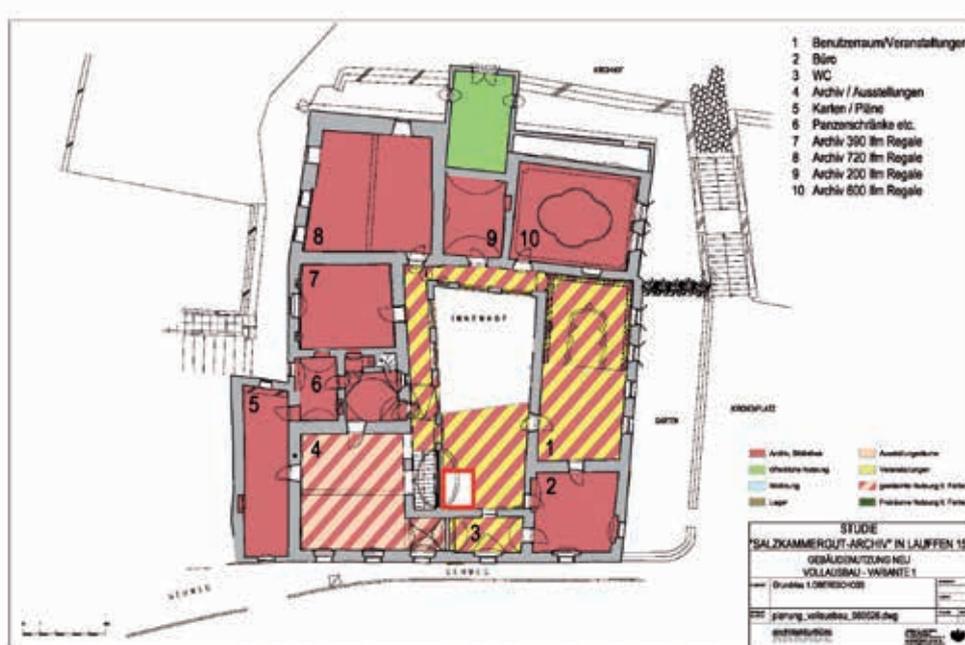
bis 16: Ausschnitte aus der Studie von 2008: Grundrisse der drei Geschosse mit farbig angelegten Raumnutzungen. Foto: Federspiel
